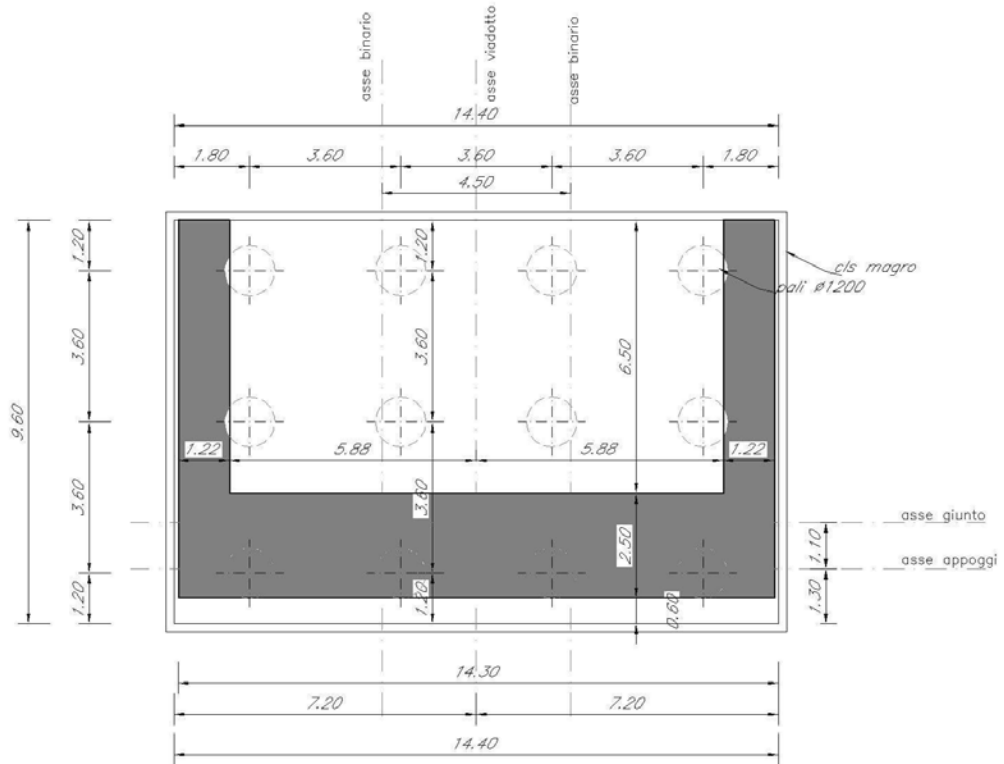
Pianta fondazioni della spalla tipo.
